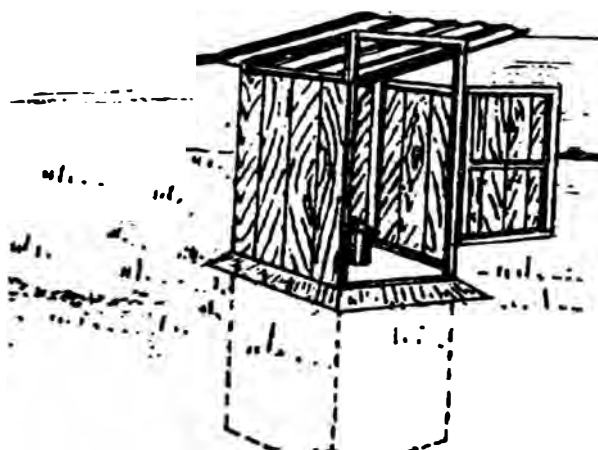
Letrina de fosa seca ventilada (excavada)
